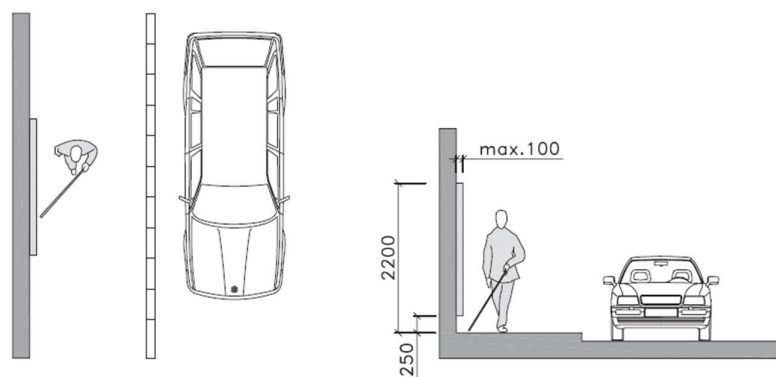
Podélné parkovací stání [Zdroj: [2]]
